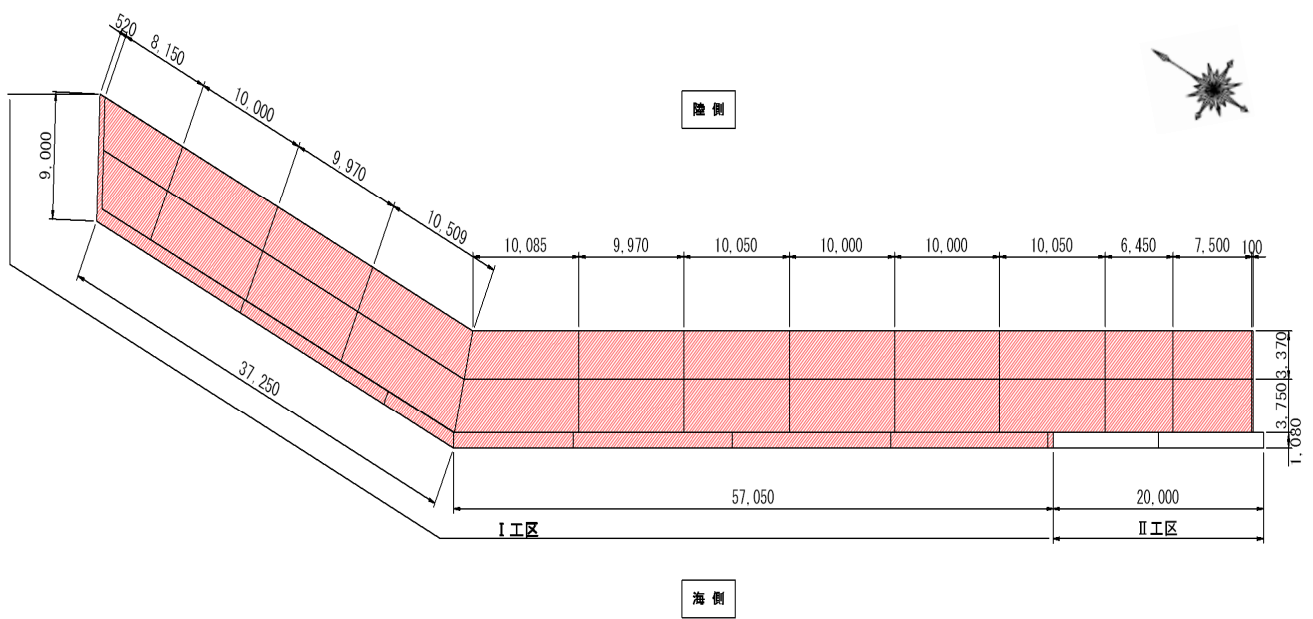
No.5 池向岸壁の平面図（被災前）
